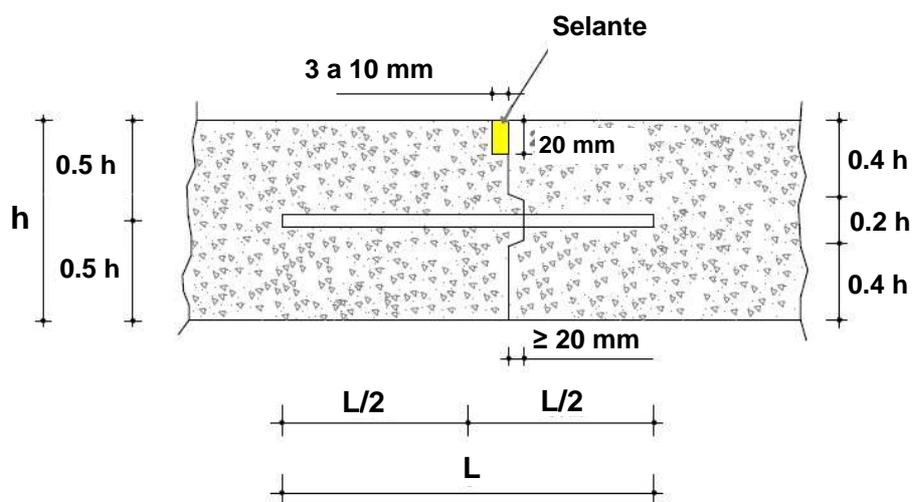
Junta longitudinal do tipo macho-fêmea e com barra de ligação.
